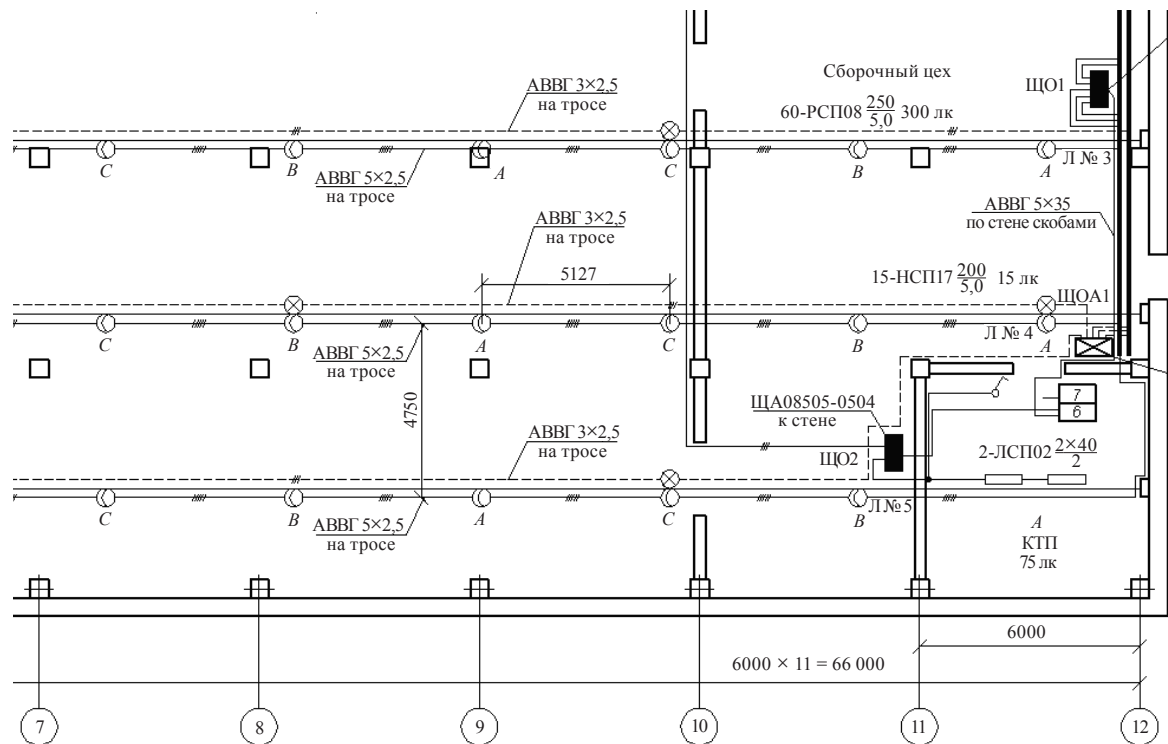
Фрагмент плана осветительной сети сборочного цеха
